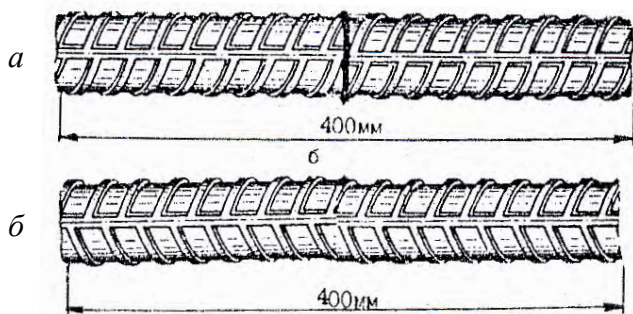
Образцы арматурной стали для определения прочности контактно-стыкового сварного соединения:
